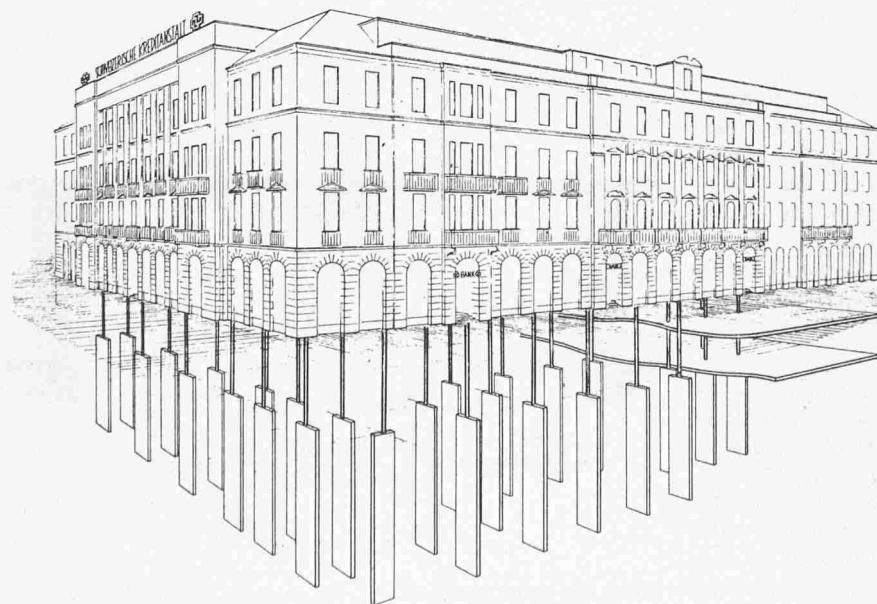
Schematische Darstellung des Schlitzpfahlverfahrens. Hauptfassade zur Bahnhofstrasse
